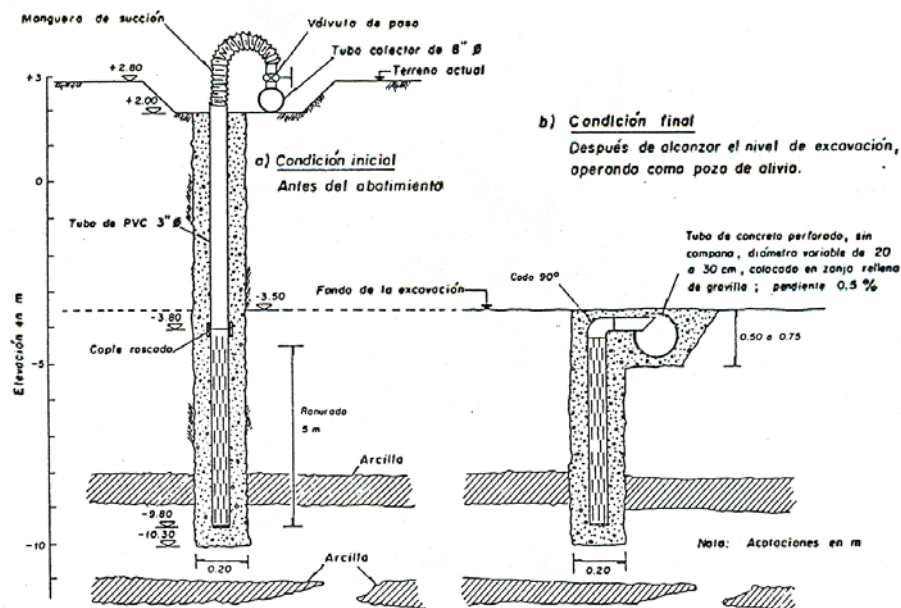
Detalles de un pozo profundo con sistema de vacío.
